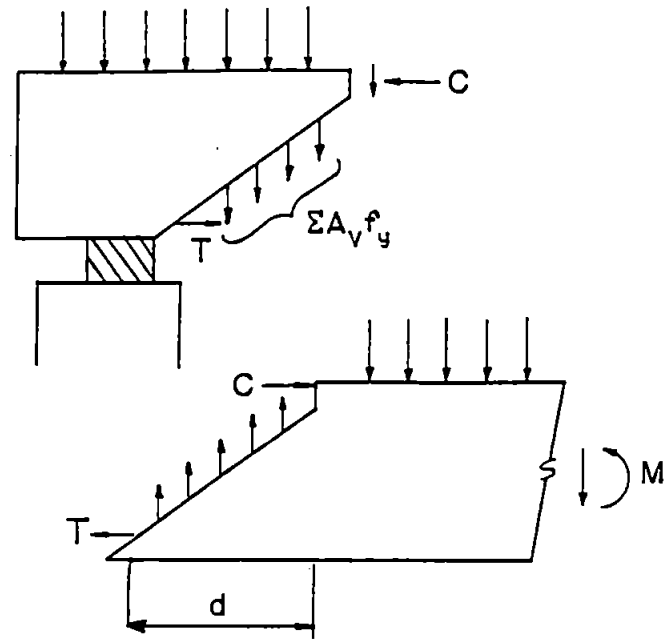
Diagrama de cuerpo libre en el extremo de la viga.
